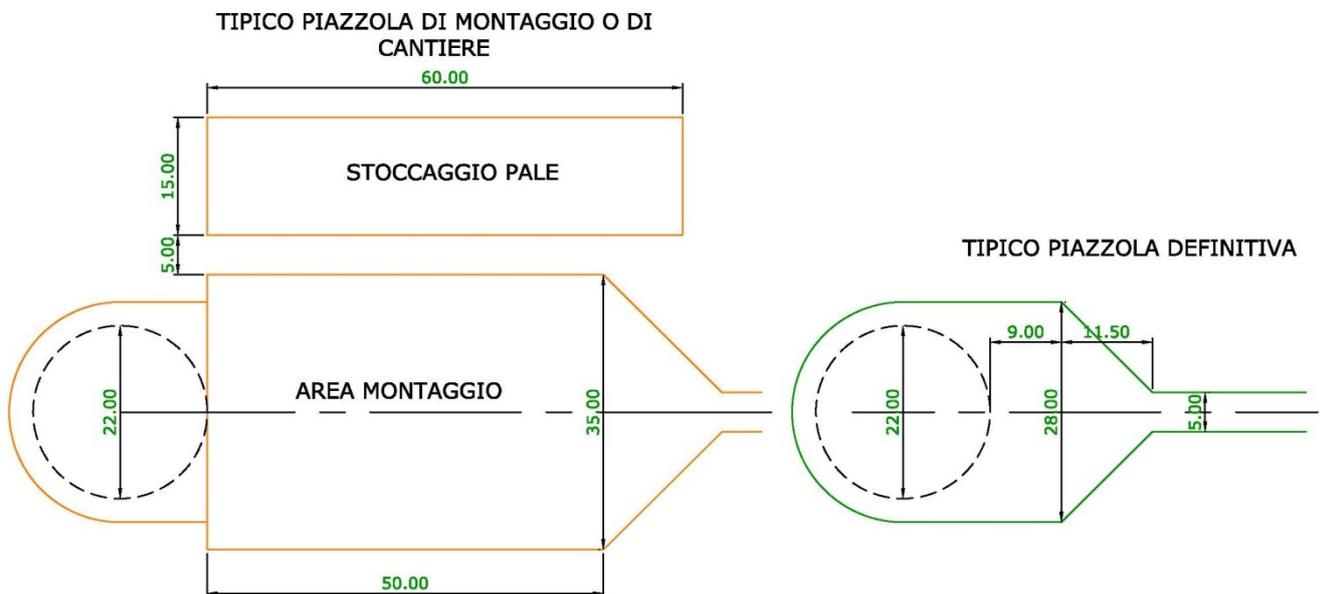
Tipiche Piazzole di Cantiere o Montaggio e Piazzola Definitiva
